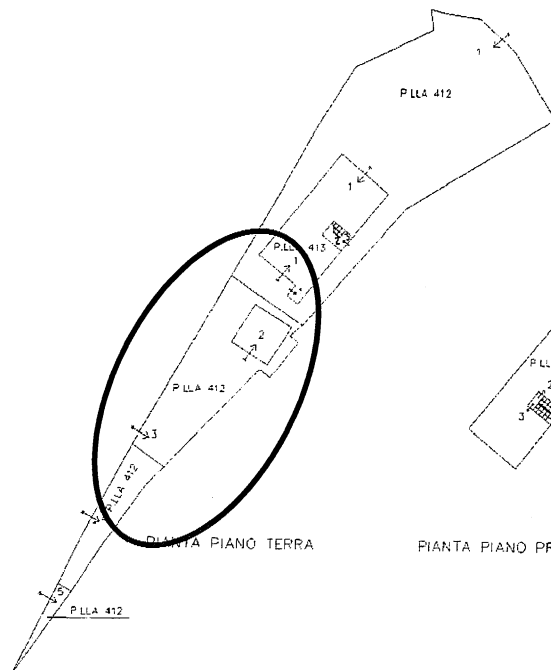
Estratto elaborato planimetrico con individuazione p.412 sub 3
